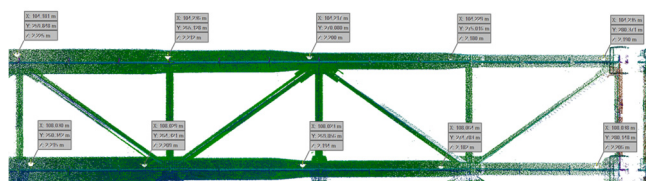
Определение строительного подъёма и схемы расположения листов нижнего пояса для сталежелезобетонного пролётного строения
